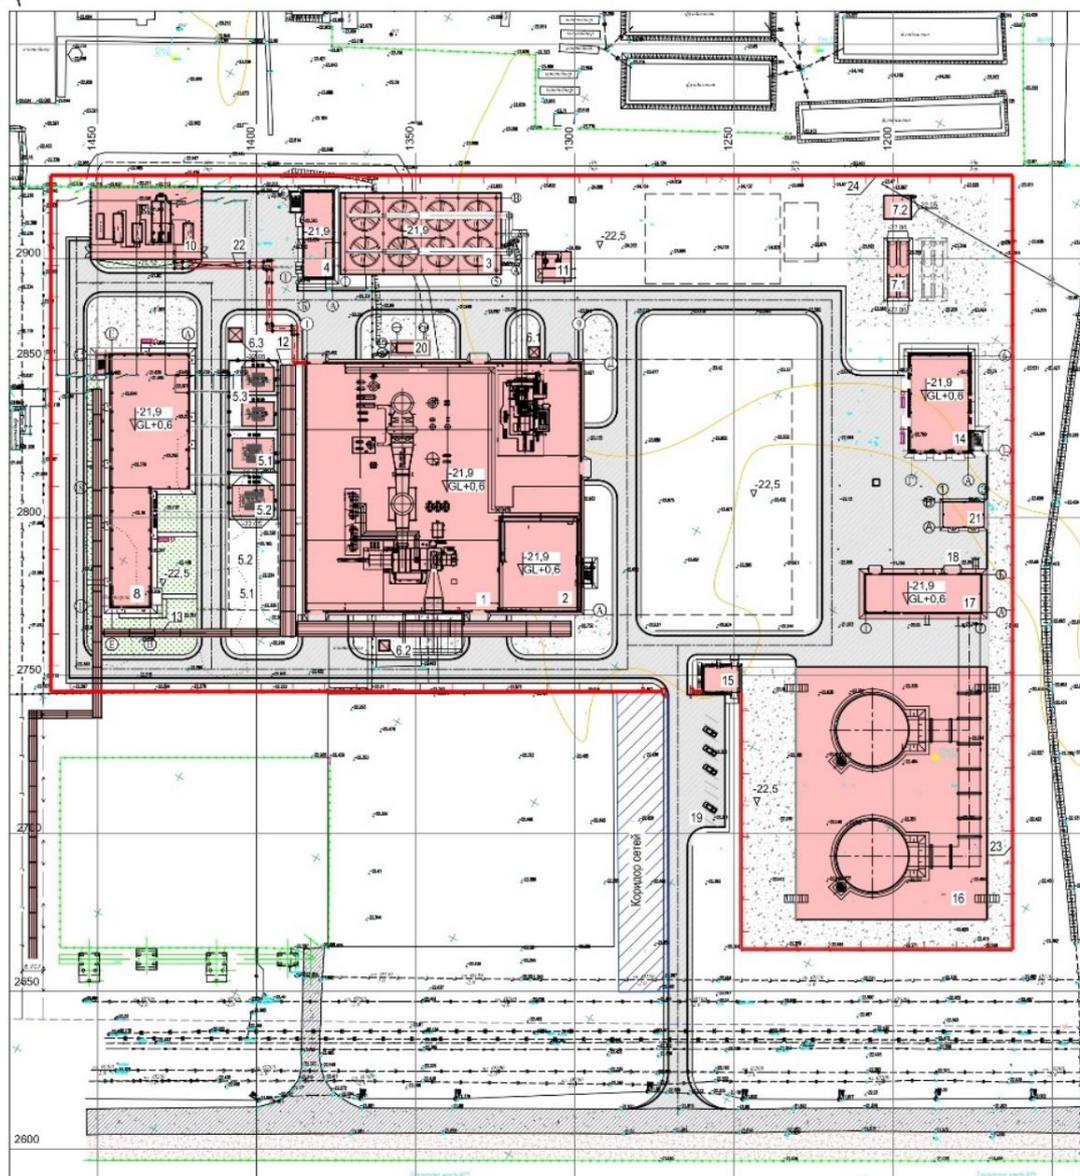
Схема генерального плана ПГУ-165 Карабатан
